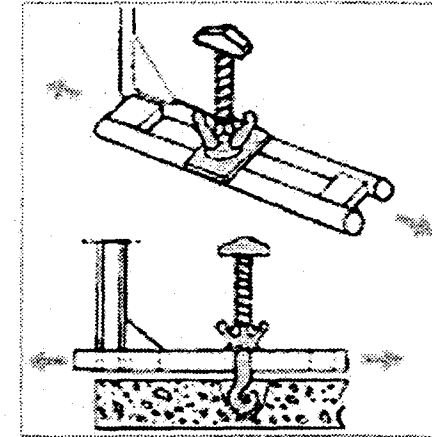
Dispositif de fixation par ancrage dans la dalle (ne doit pas être fabriqué sur chantier, mais par un fabricant spécialisé).
